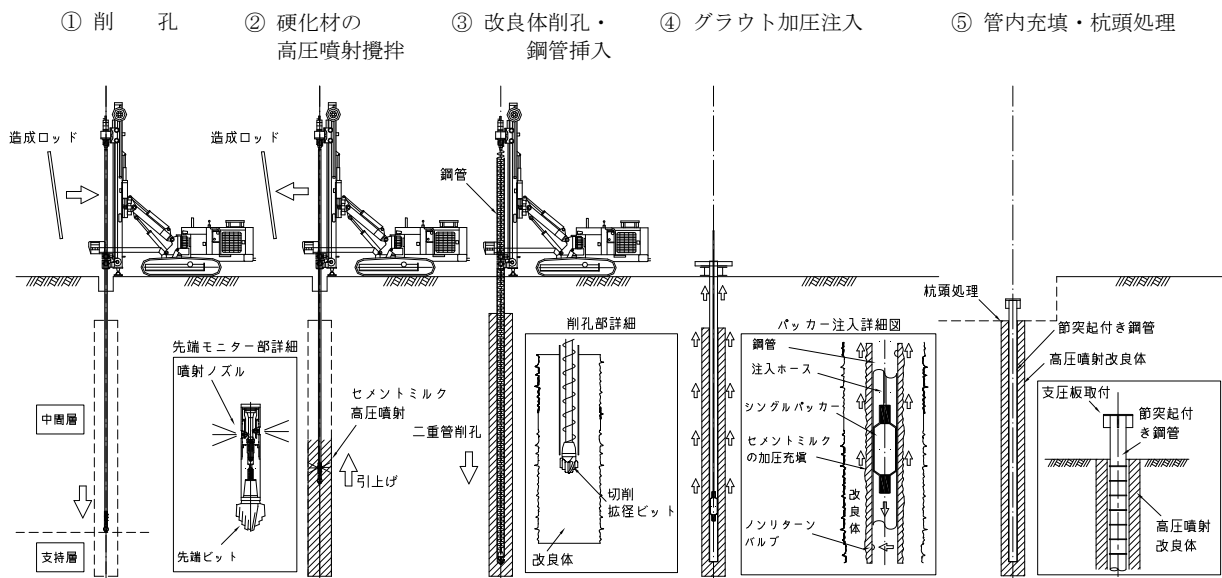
ST マイクロパイル工法タイプIIの標準的な施工手順
